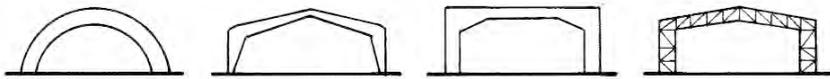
Arcs et portiques constituant des éléments de contreventement vertical.
